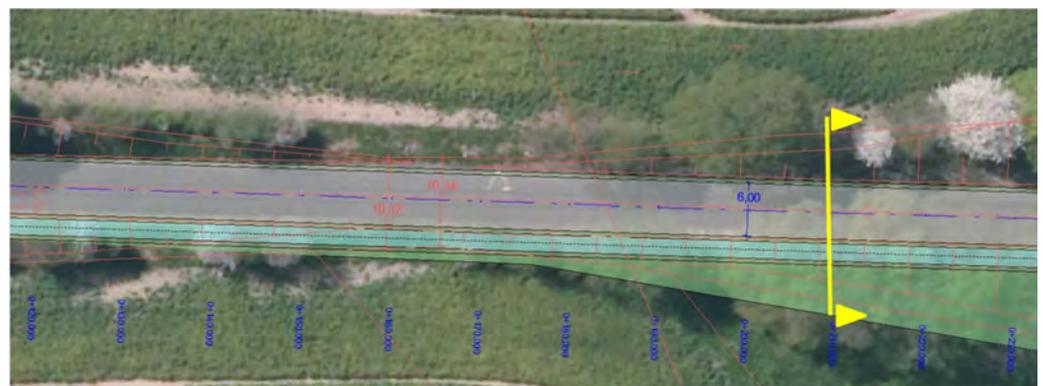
Querschnitt Q1 - Lageplanausschnitt
